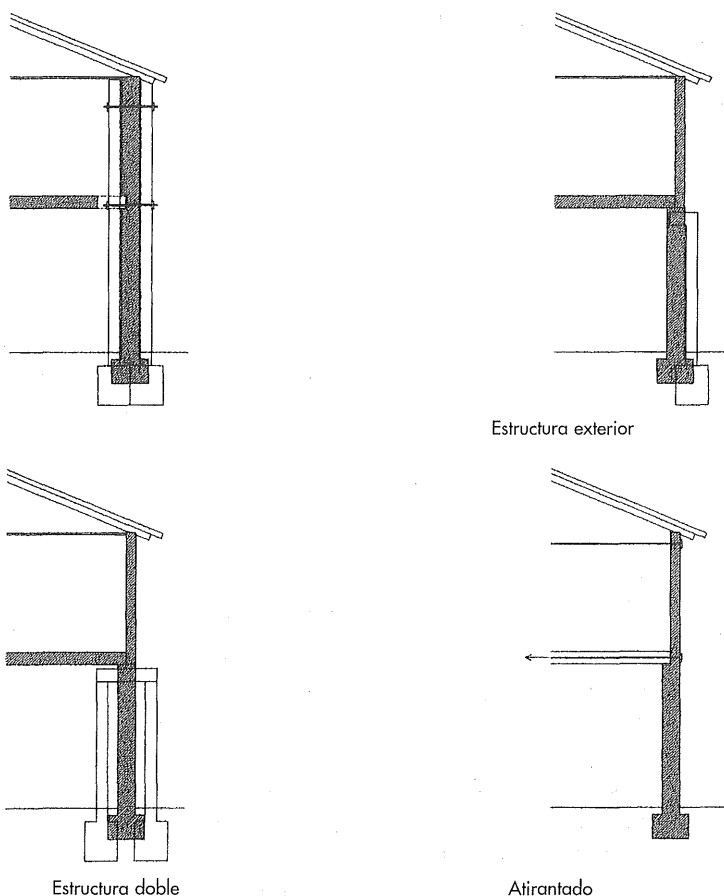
Reparación de muros de carga con nueva estructura.
